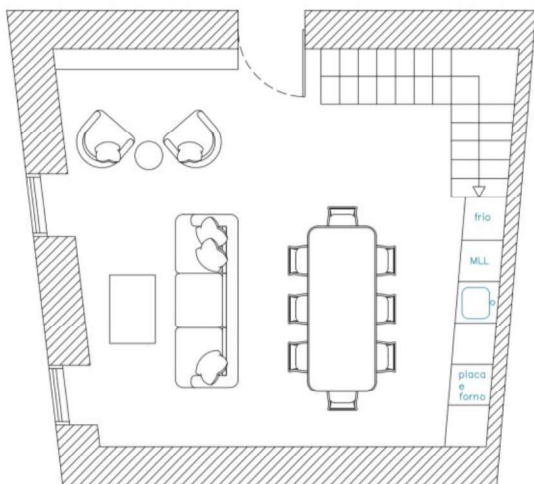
Planta do alojamento rural, proposta II, piso inferior. Fonte: Autor
